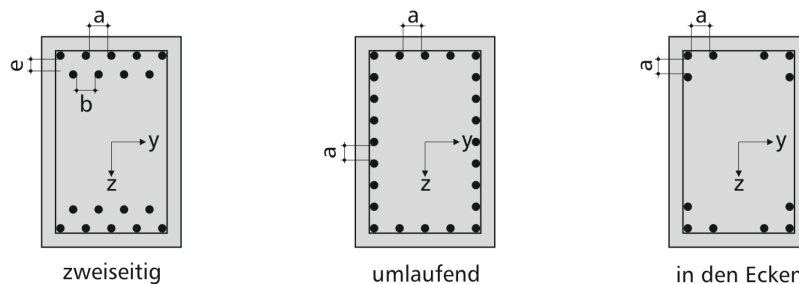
Abstände a , b und e der Bewehrungsstäbe
